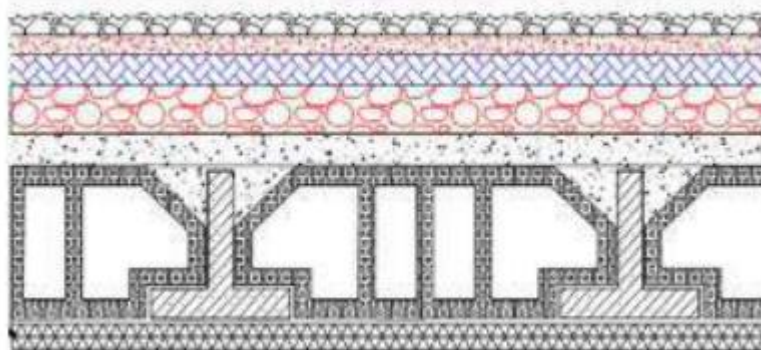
Coupe d'un plancher terrasse inaccessible
